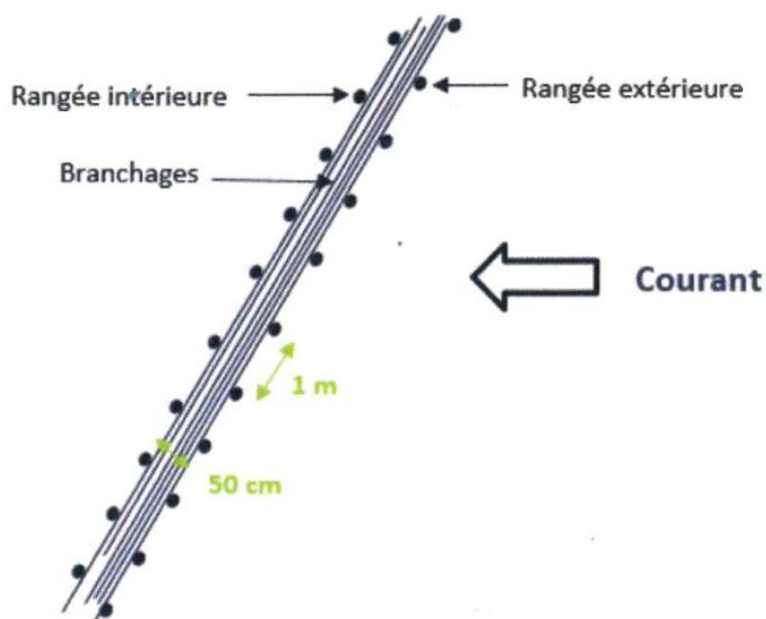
Plan de principe détaillé du dispositif d'accrétion (variante 2)
